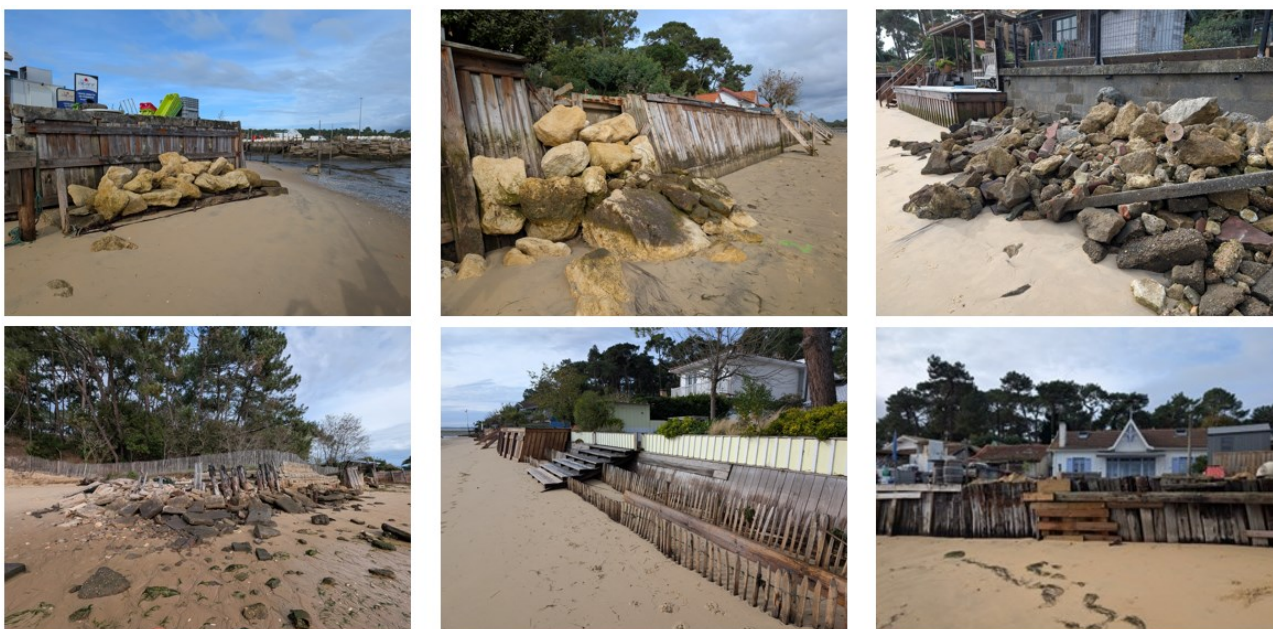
Exemples de réparation ponctuelles d'ouvrages longitudinaux à partir de matériaux divers et non consolidés.
